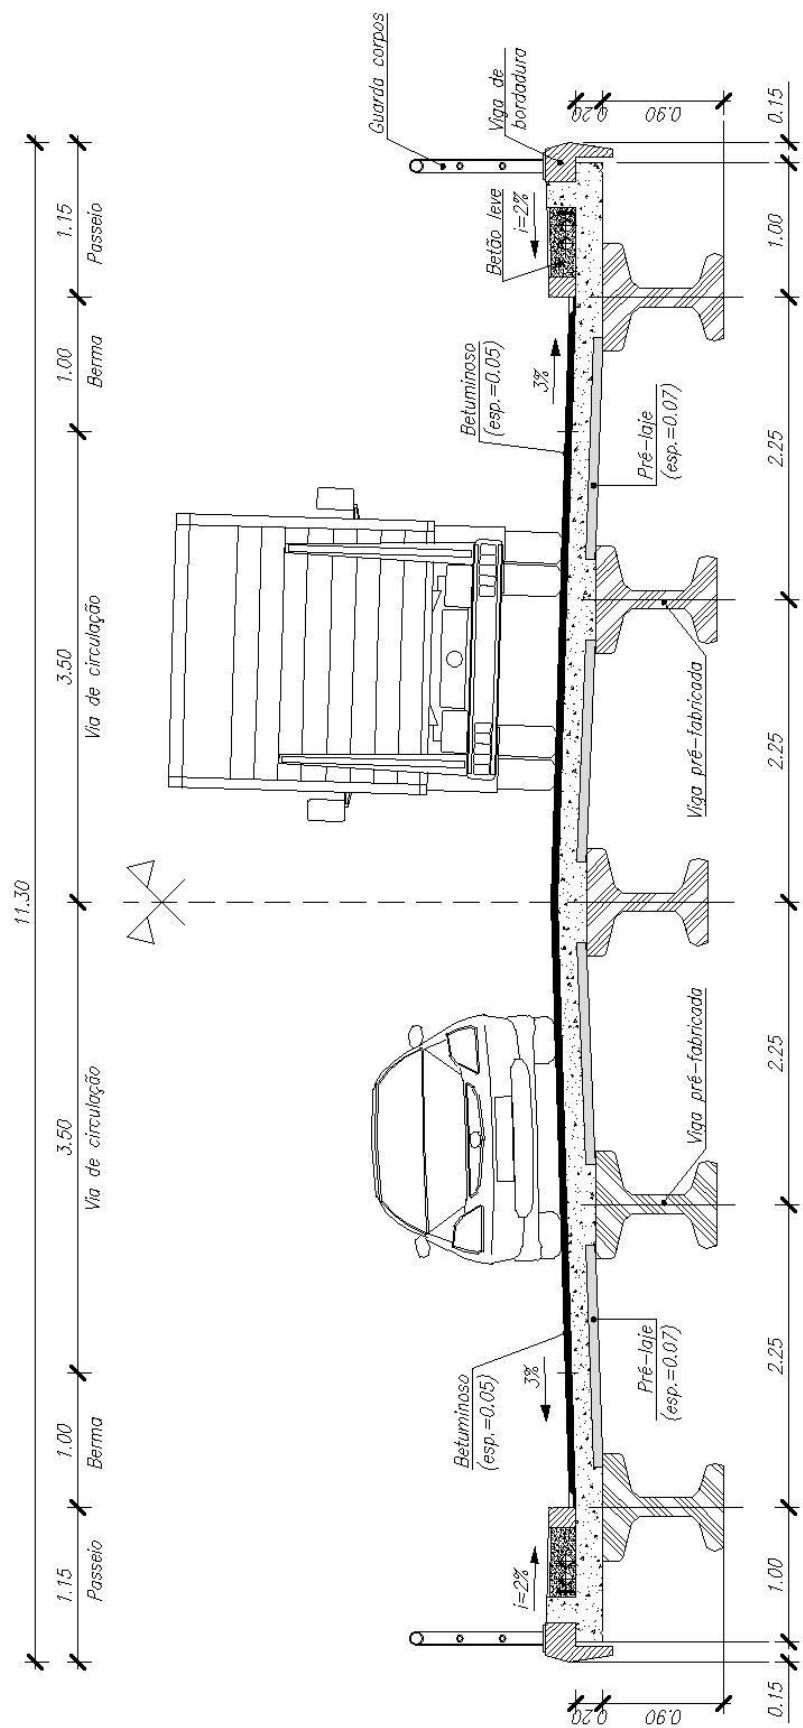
Seção transversal e perfil da via do tabuleiro de vigas pré-fabricadas
